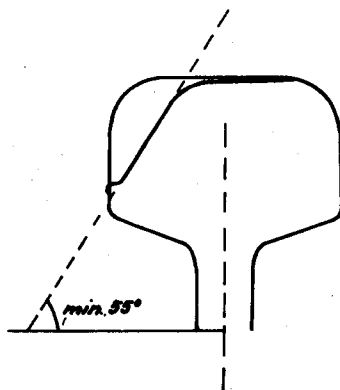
Měření úhlu bočního ojetí v místě, kde se současně ojíždí jazyk s opornicí
